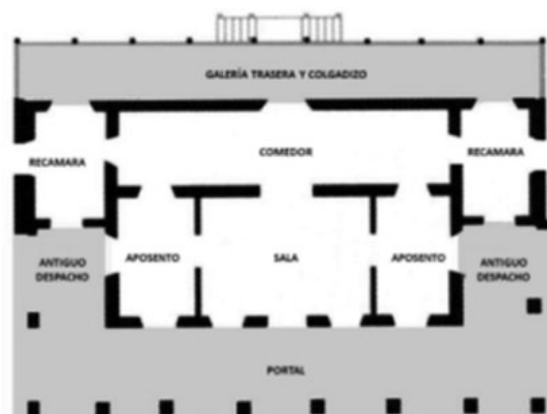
Vista en planta de la casa de vivienda del Ingenio Manaca Iznaga. Fuente: (López, Benítez, Chaviano, & Echenagusía, 2003)
